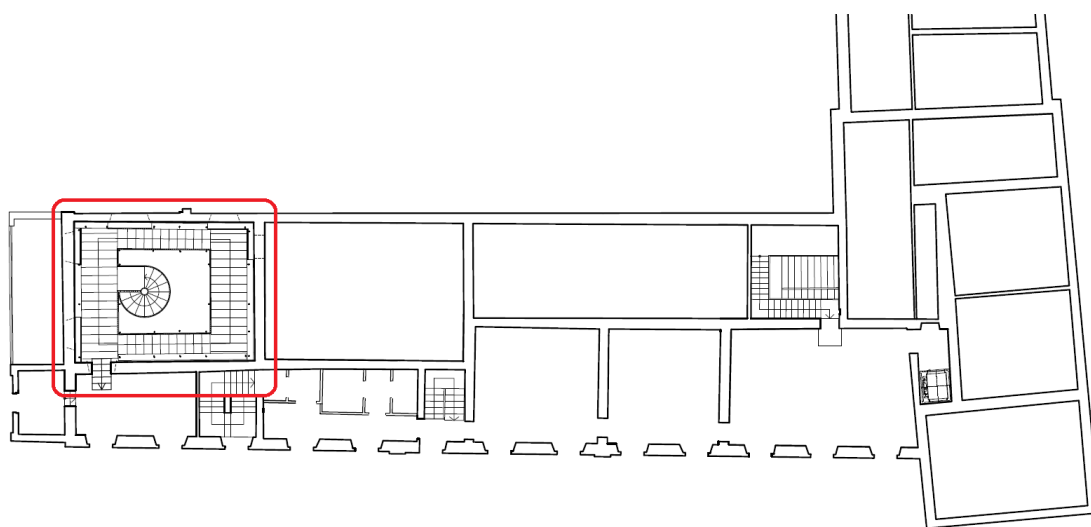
Ubicazione del nuovo ballatoio, pianta piano ammezzato
